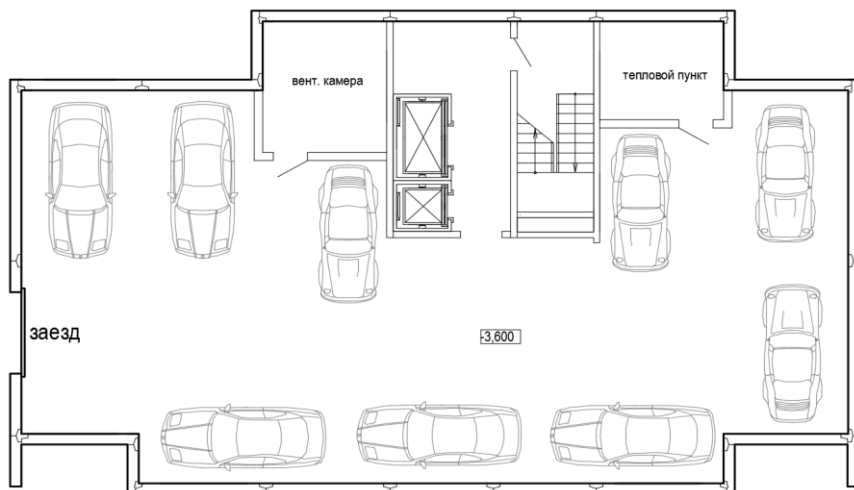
План -1 этажа жилого дома с организованной подземной парковкой.
